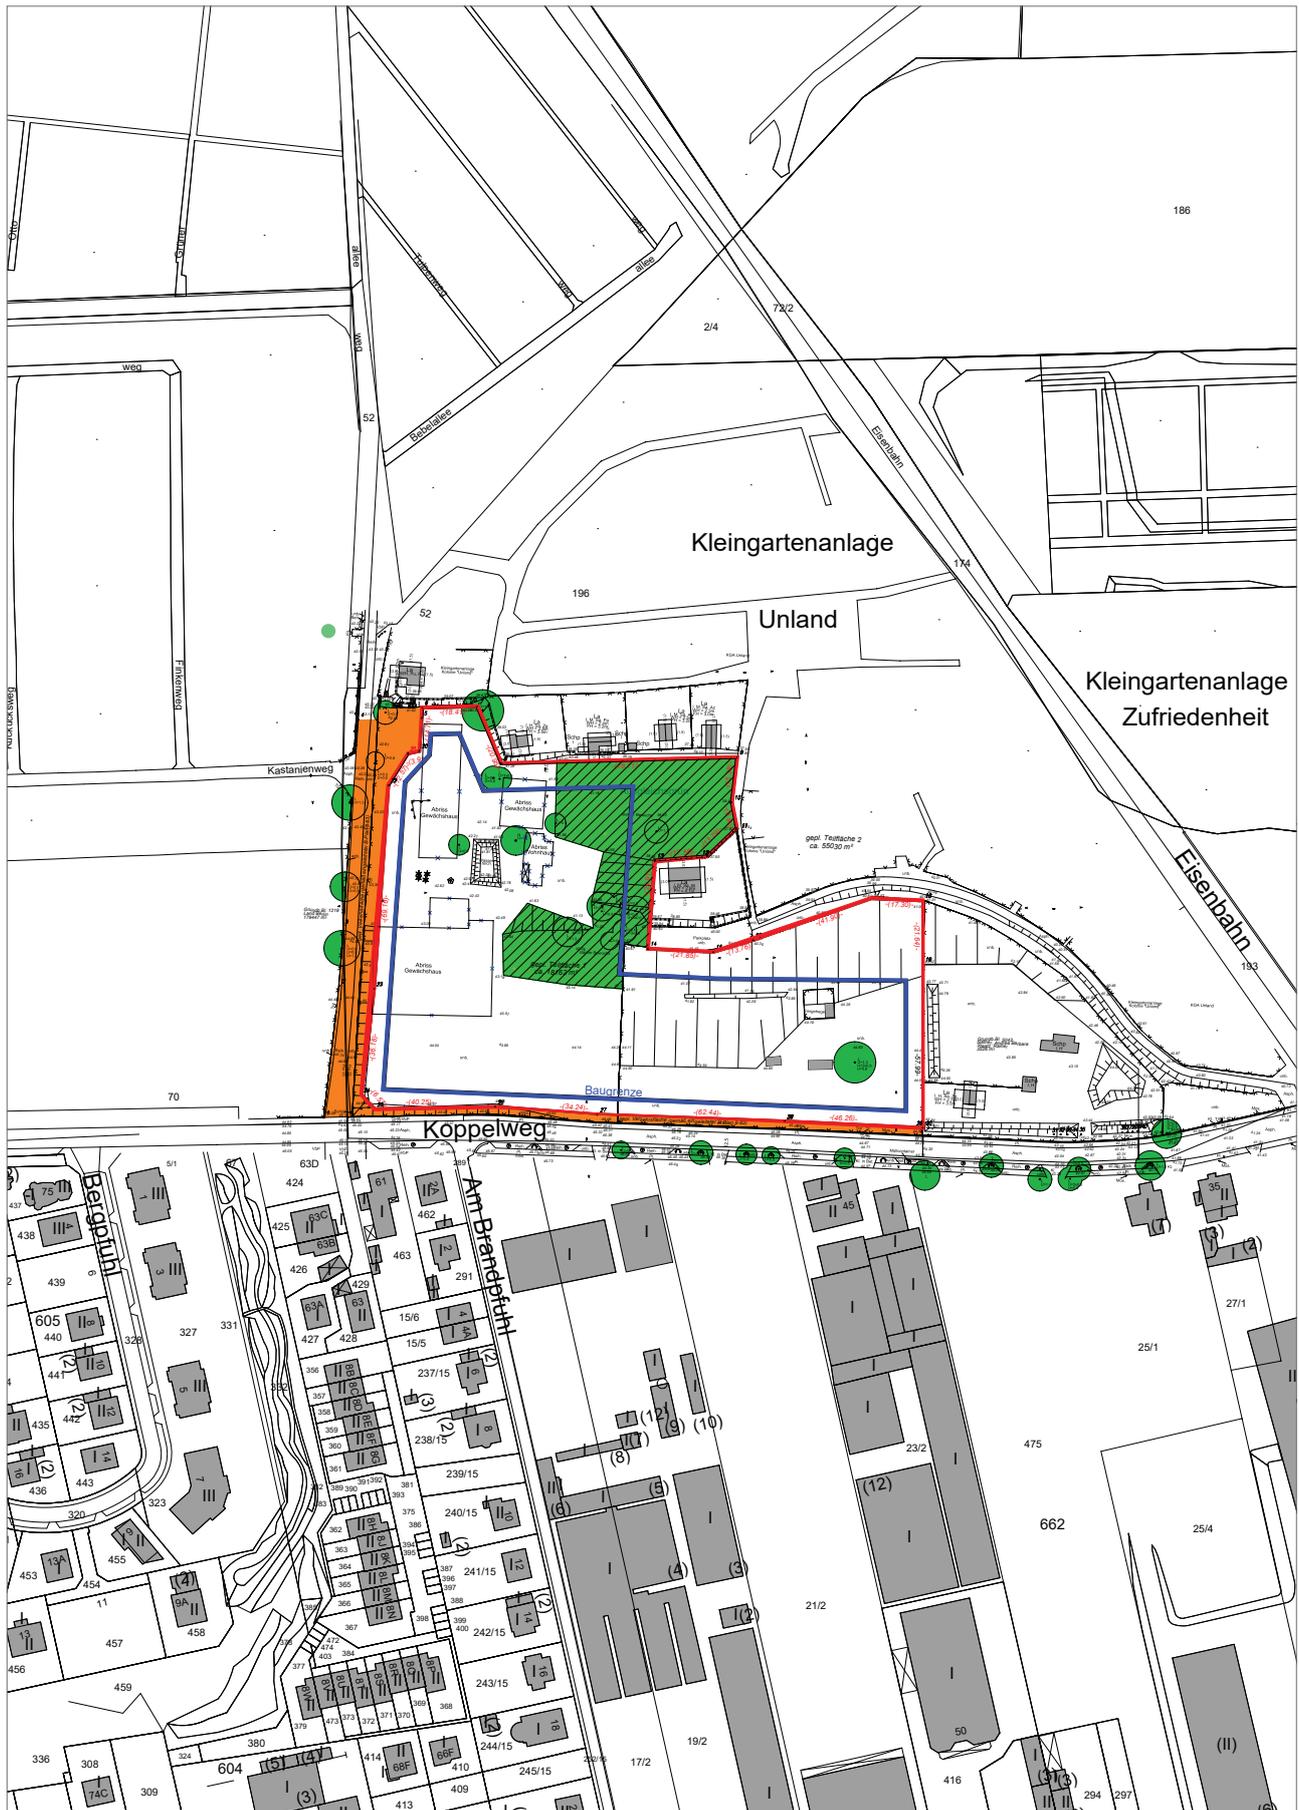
Wettbewerbsgrundstück (rot) mit schraffierter Ausgleichsfläche (grün), Baugrenze gemäß Bebauungsplanentwurf (blau)
